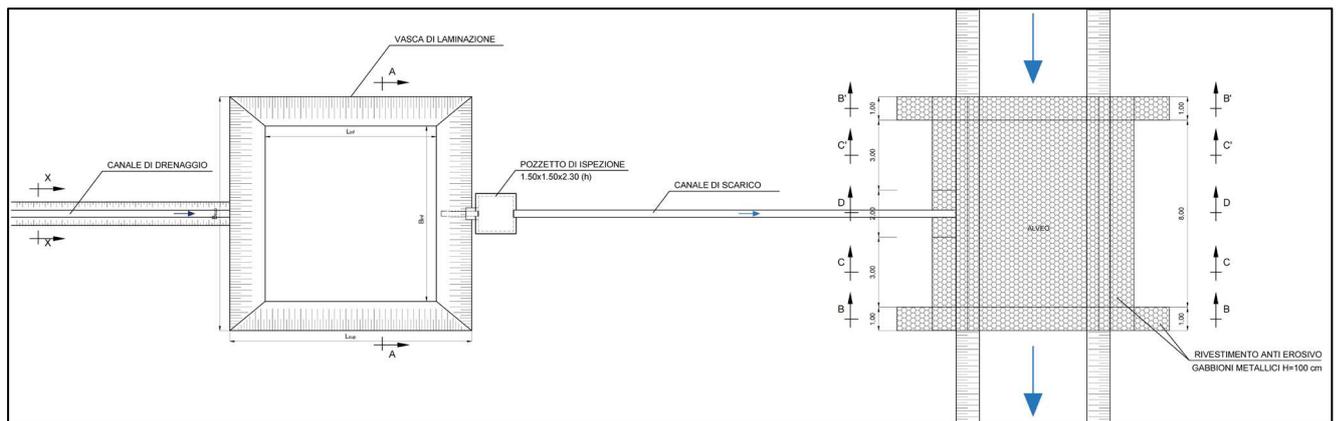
Planimetria Sistema vasca di laminazione e recapito
